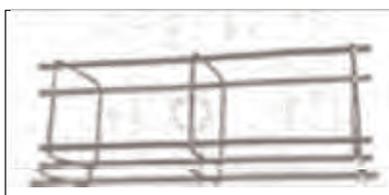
Atado de barras de ferralla con puntos de soldadura
